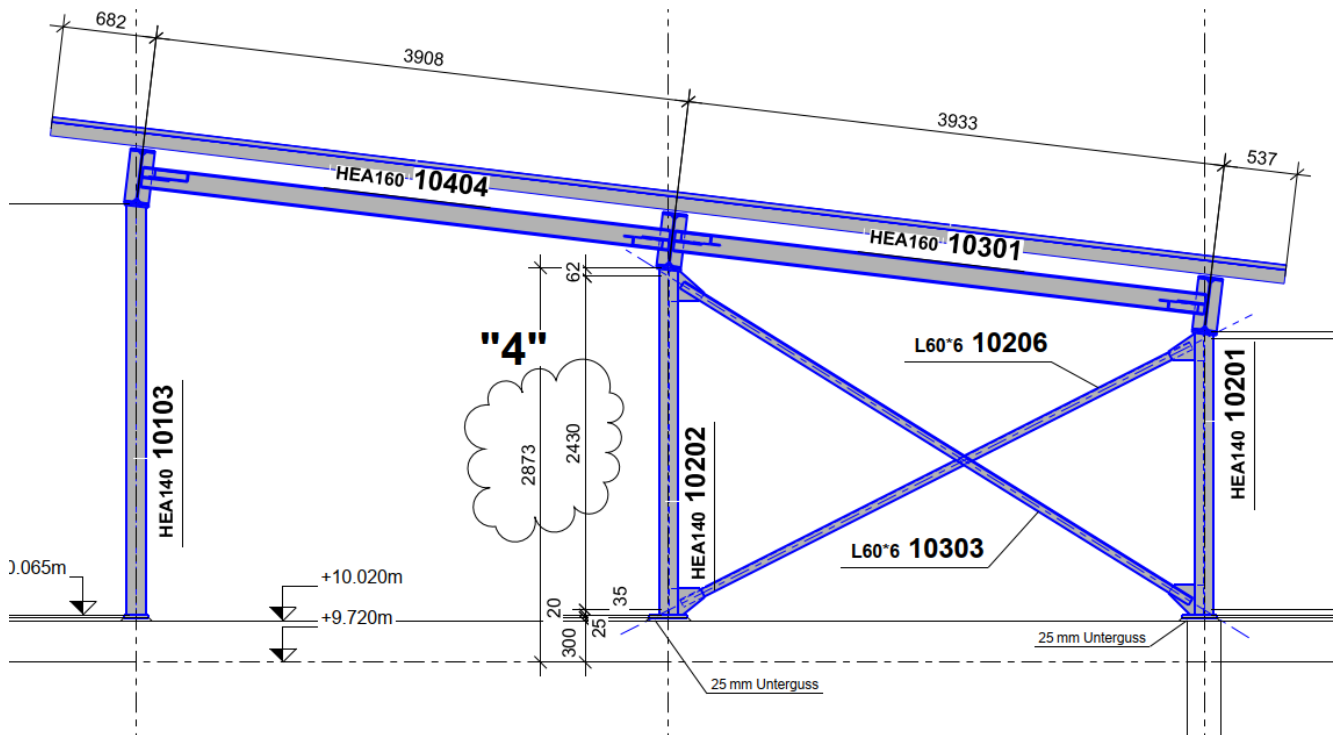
Planausschnitt Überdachung Schlammagerplatz
